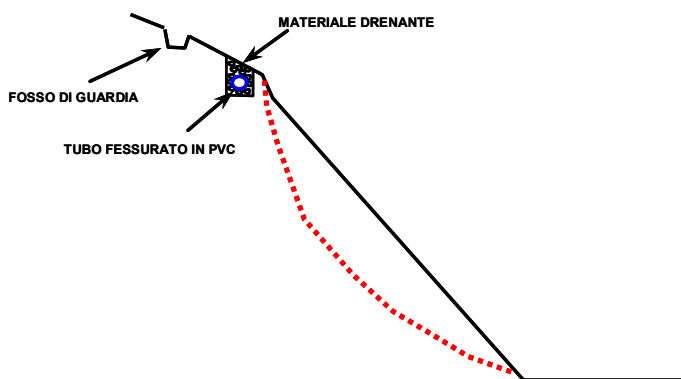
Rappresentazione schematica di un dreno intercettore; la linea in tratteggio rosso rappresenta la superficie di scivolamento della frana -
